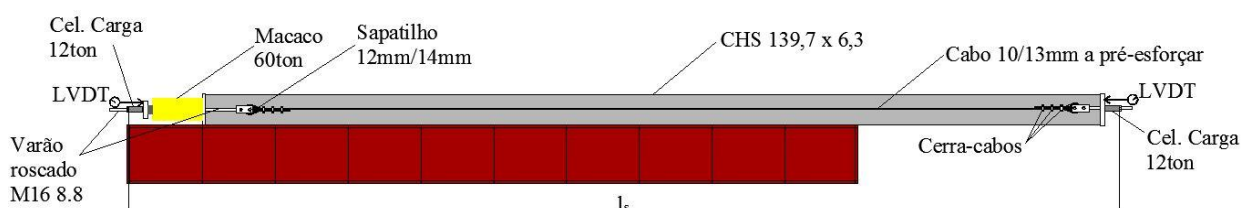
Vista longitudinal do *layout* de ensaio dos cabos
